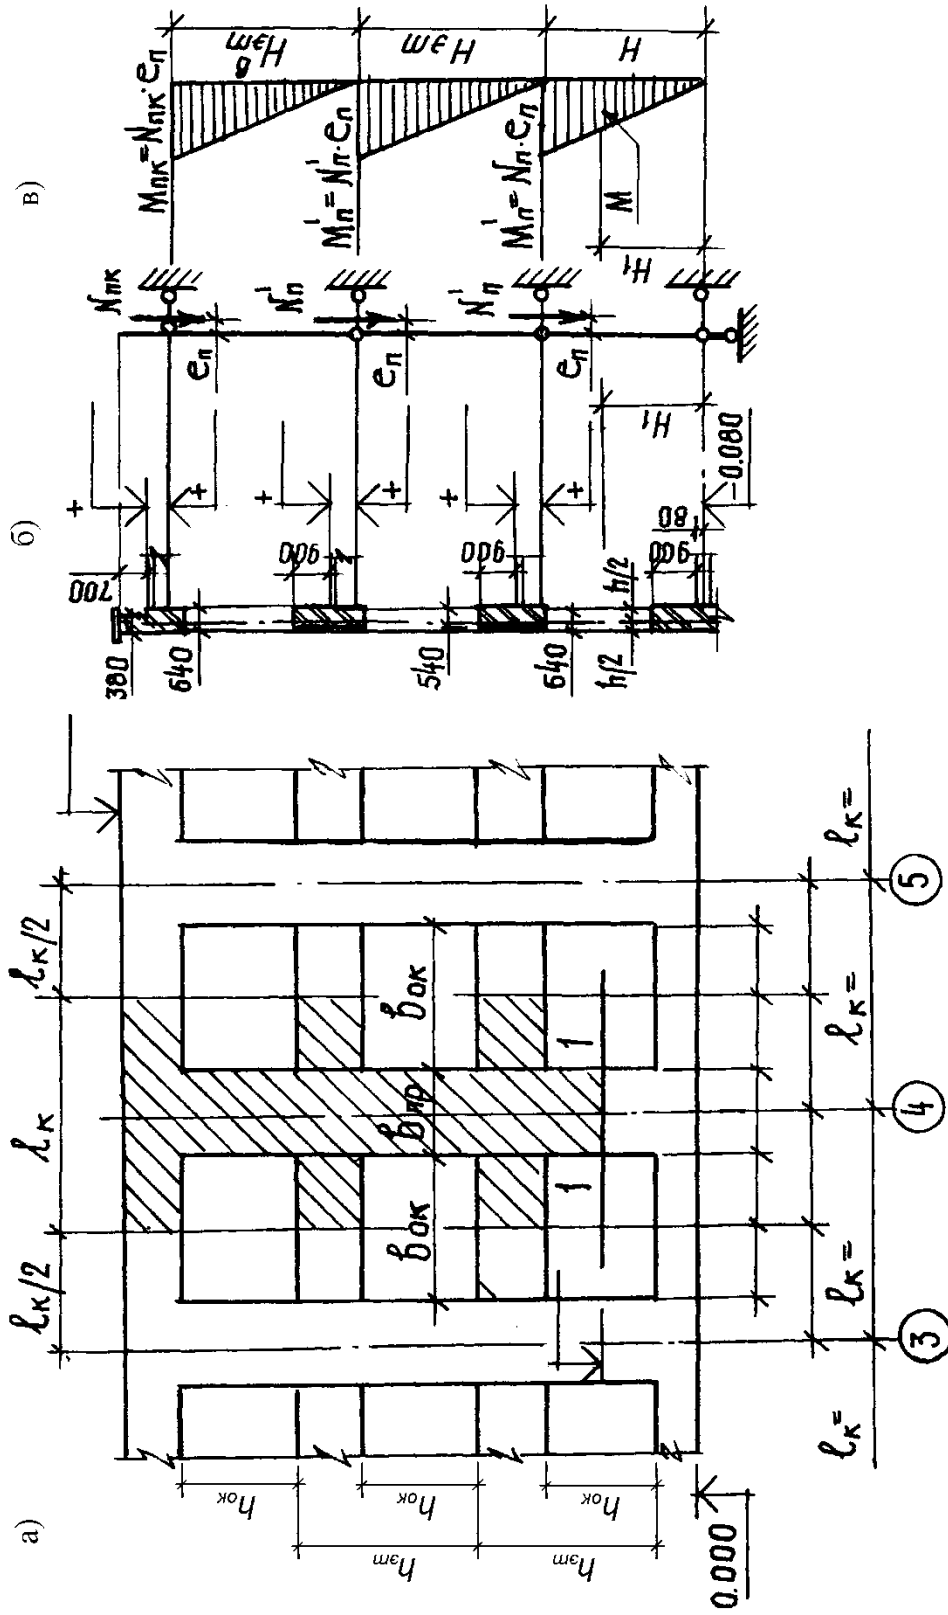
а) Фрагмент фасада; б) разрез по наружной стене, в) эпюра моментов
